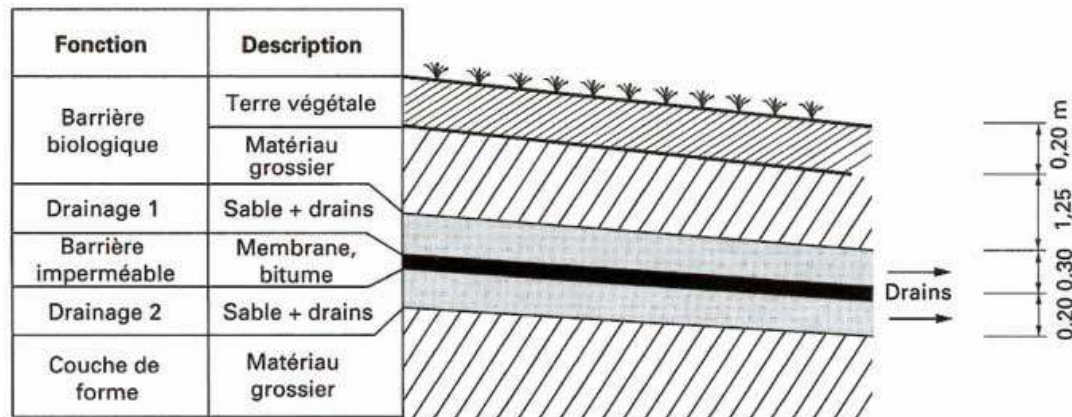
Couverture du Centre de stockage de la Manche (ANDRA)
